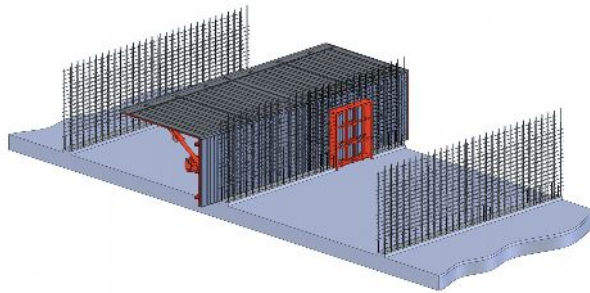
Köşebent ve beton kesici elemanlar.
